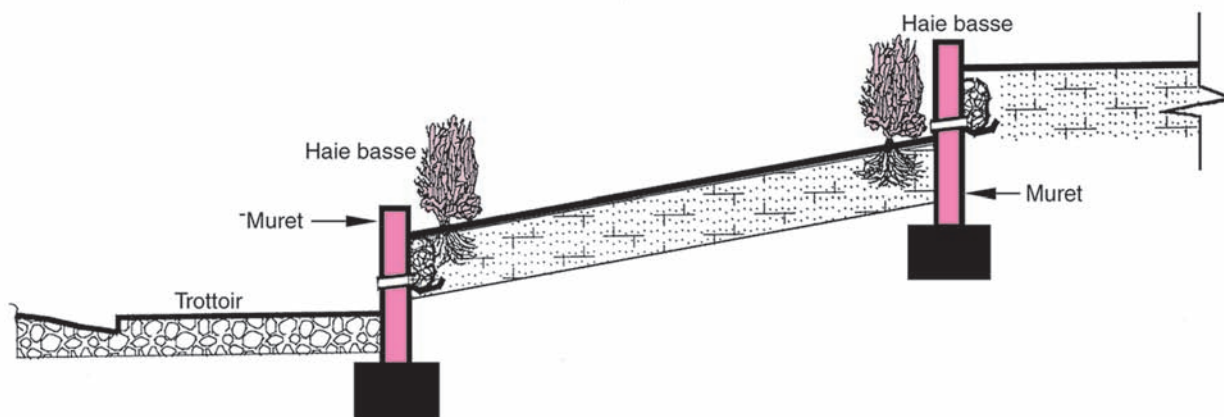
Adaptation par ressauts, murets de soutènement et haies basses
